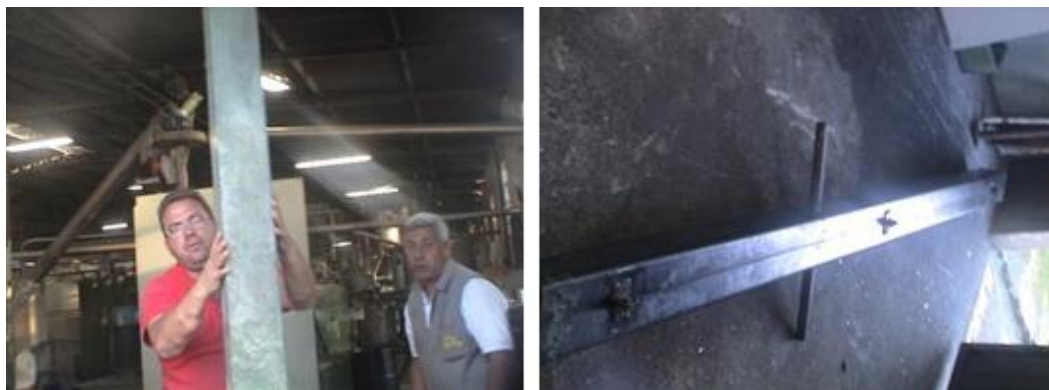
FOTOS DA MOLDAGEM DE UM DOS PROTÓTIPOS (14,5X14,5cmX3m) EM FÁBRICA DE ITAJAÍ.
